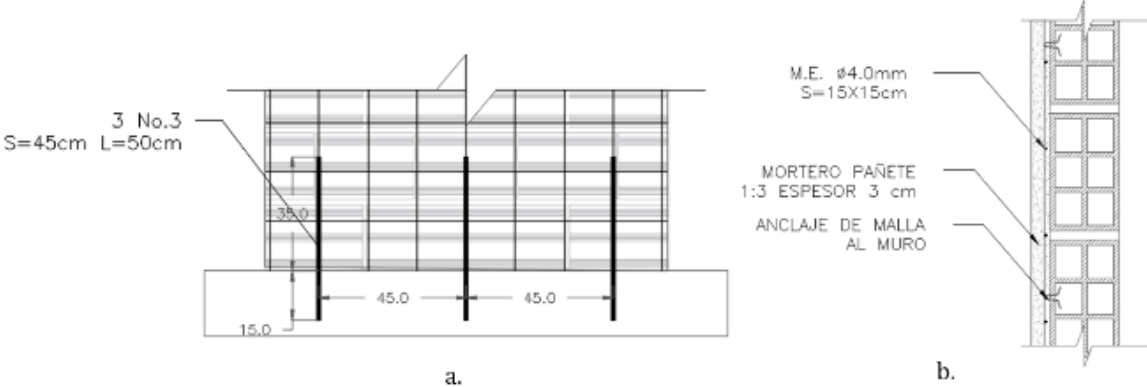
Detalles a. Anclaje de varillas a viga de cimentación; b. Anclaje de malla al muro.
